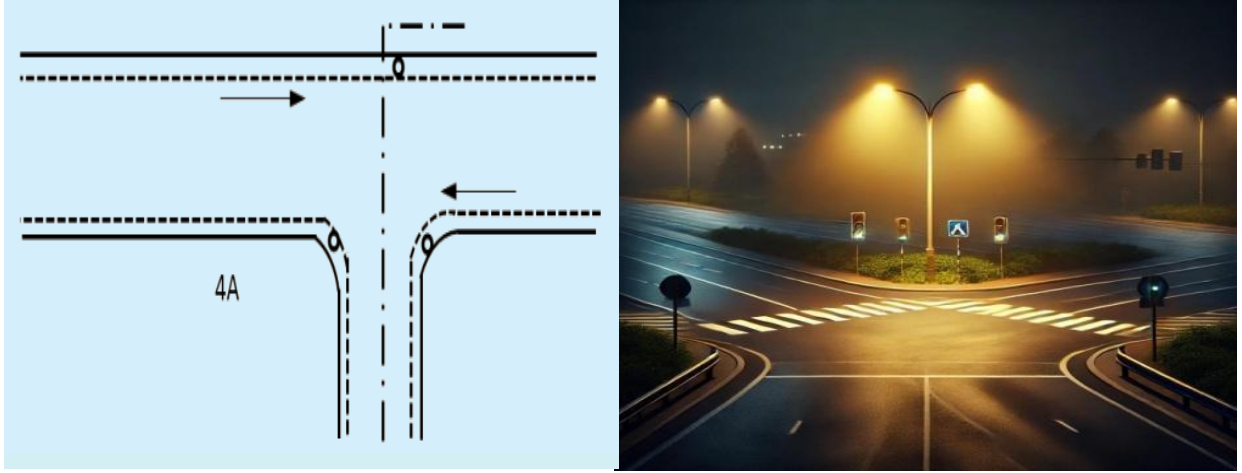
साधा दोन रस्त्यांचा चौकचा लाइटिंग लेआउट (Lighting layout for Simple two road junction)
